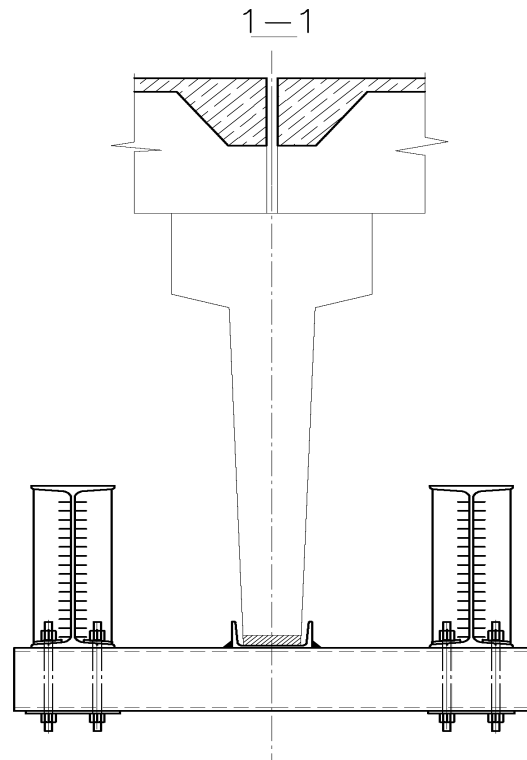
Залізобетонна балка покриття L = 12м в прольоті «А-Б». Переріз балки.
